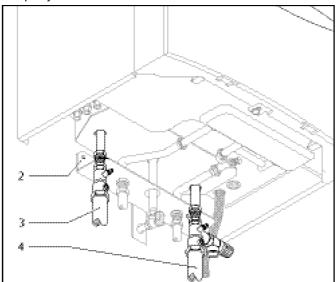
Подающий трубопровод и обратный трубопровод системы отопления
